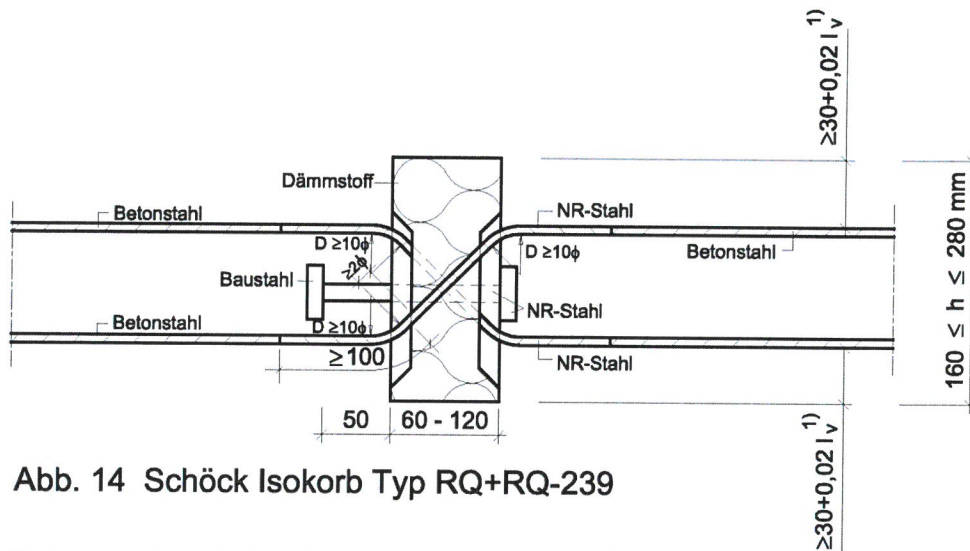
Schöck Isokorb Typ RQ+RQ-239
